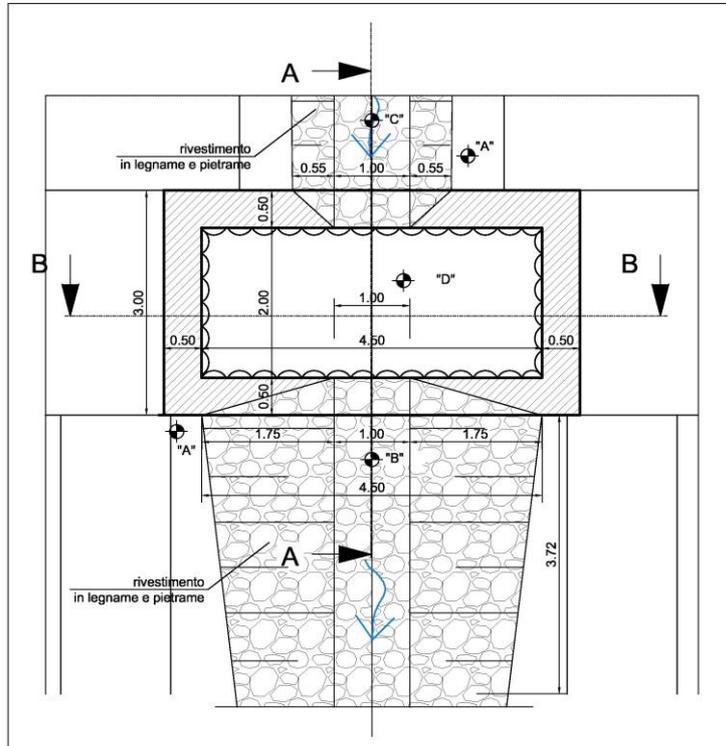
Compluvio centrale – Vasca tipo Vi2-3-3 - pianta
